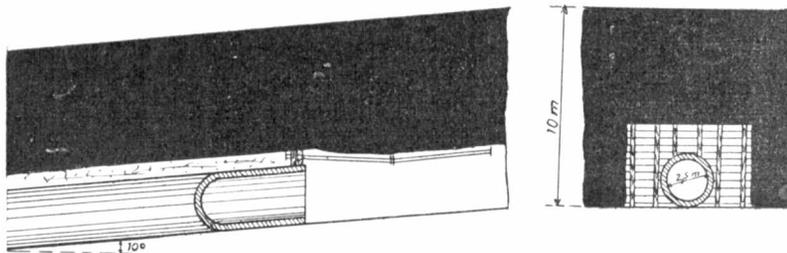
Aussparung einer gemauerten Strecke im Versatz.
